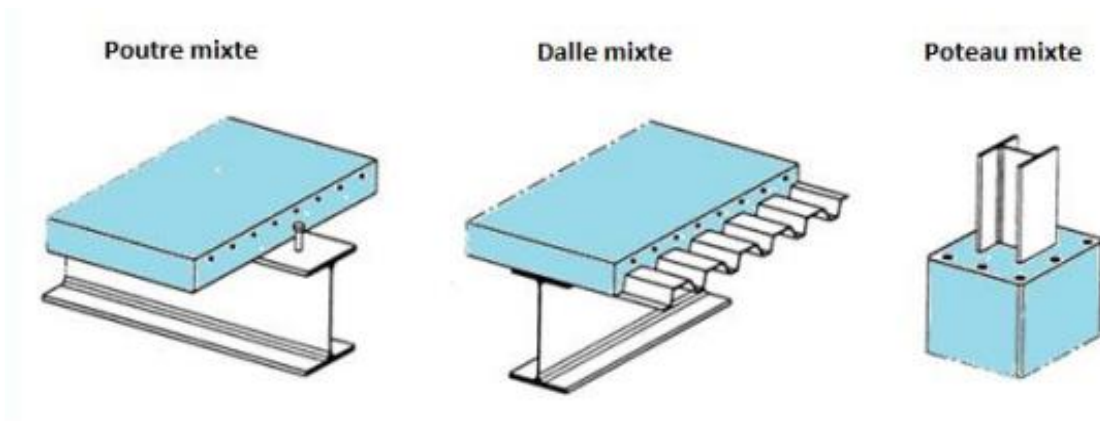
Exemples d'éléments mixtes (acier, béton)
